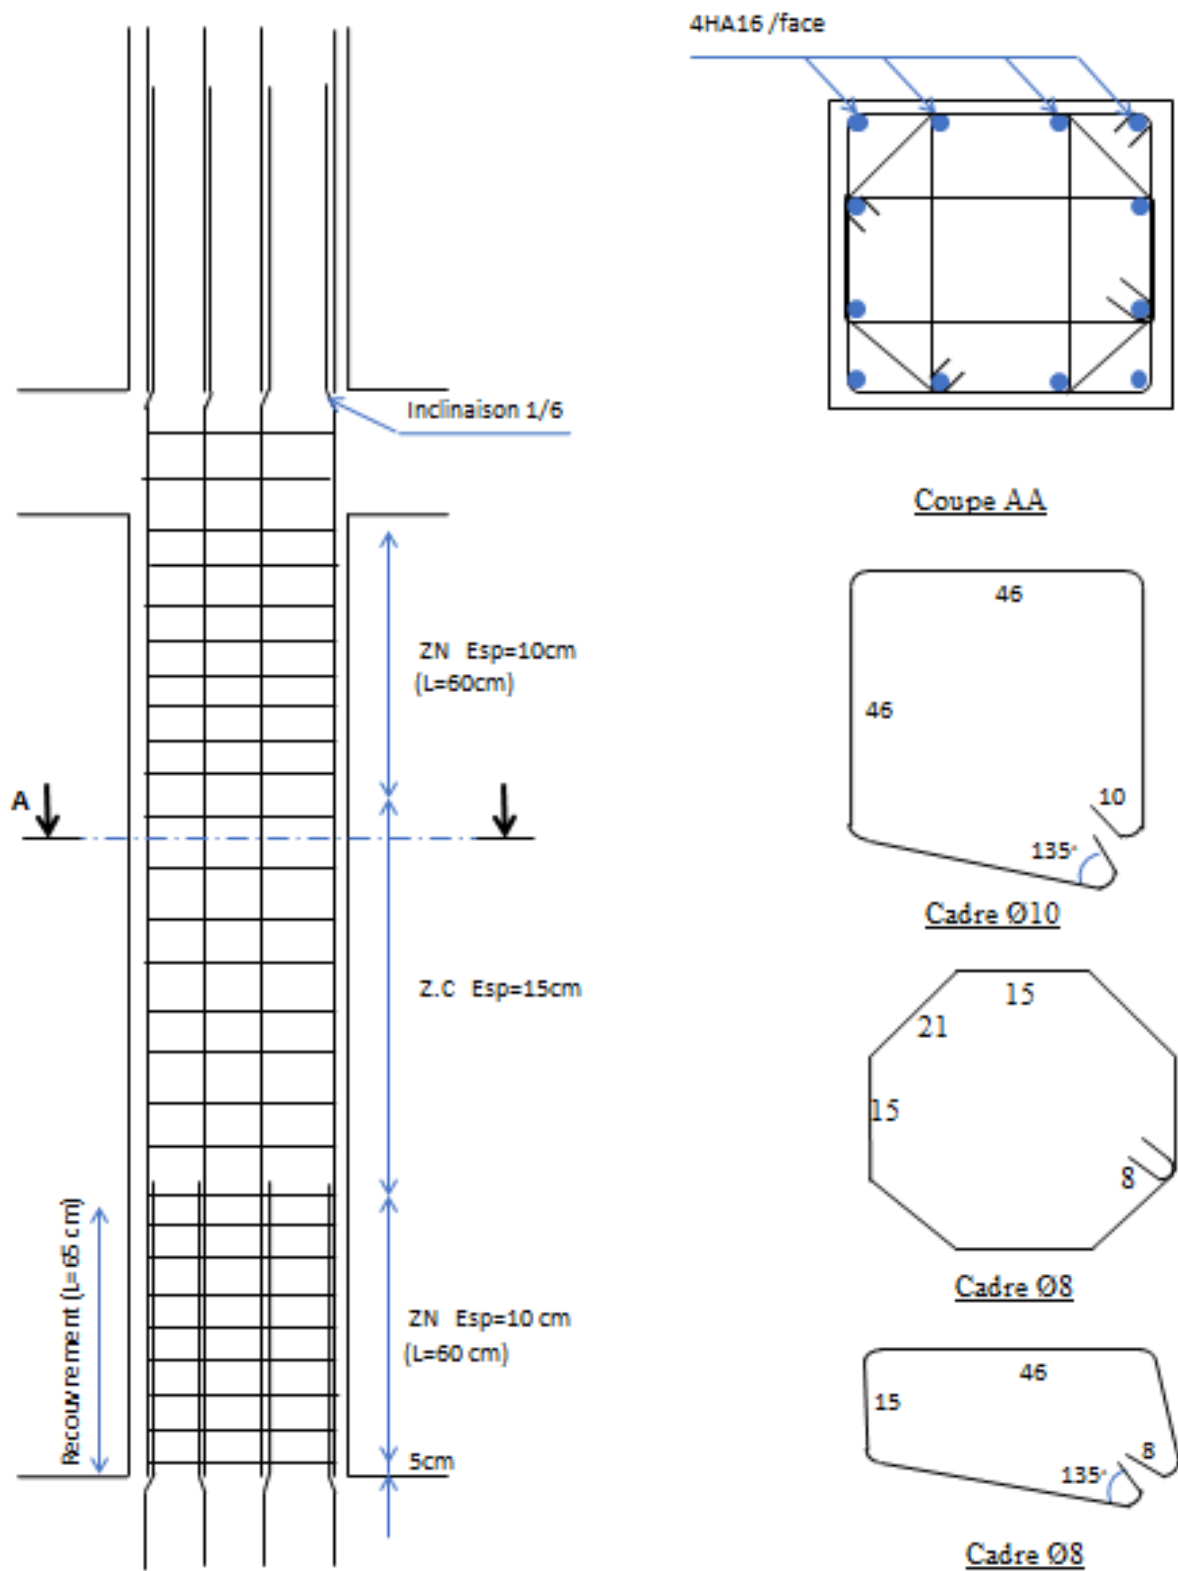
Schéma de Ferrailage du Poteau 50\*50
